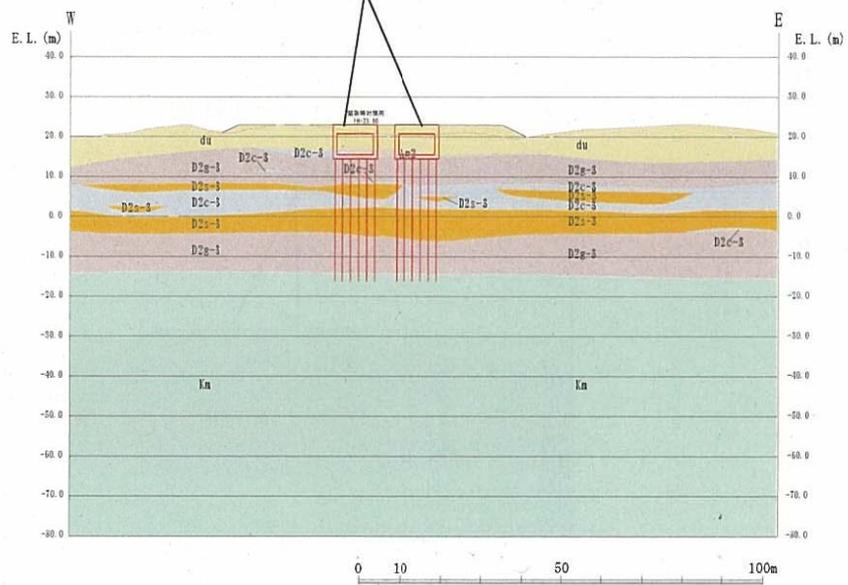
(1) 耐震評価候補断面位置及び地質断面図 (その1)
